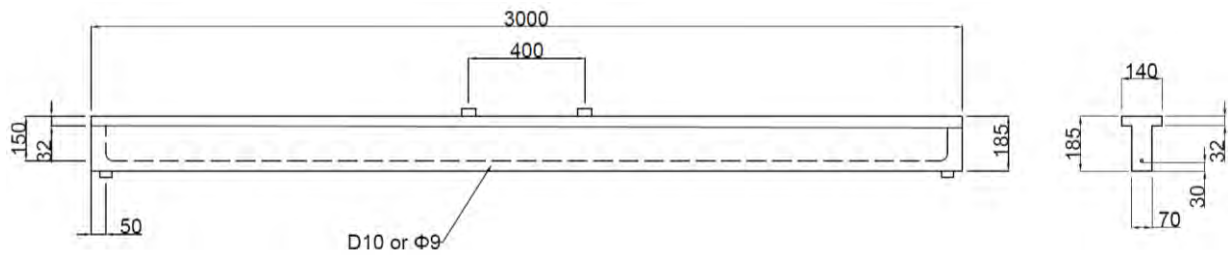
T形断面 RC 梁の寸法および配筋（かぶり厚さ 30 mm）
